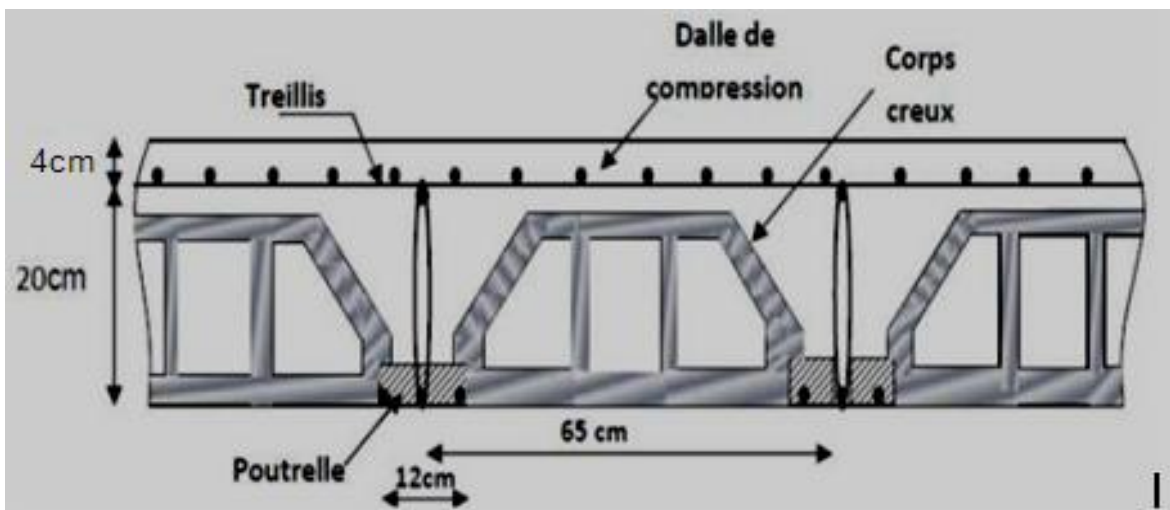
Schéma descriptif d'un plancher en corps creux.
